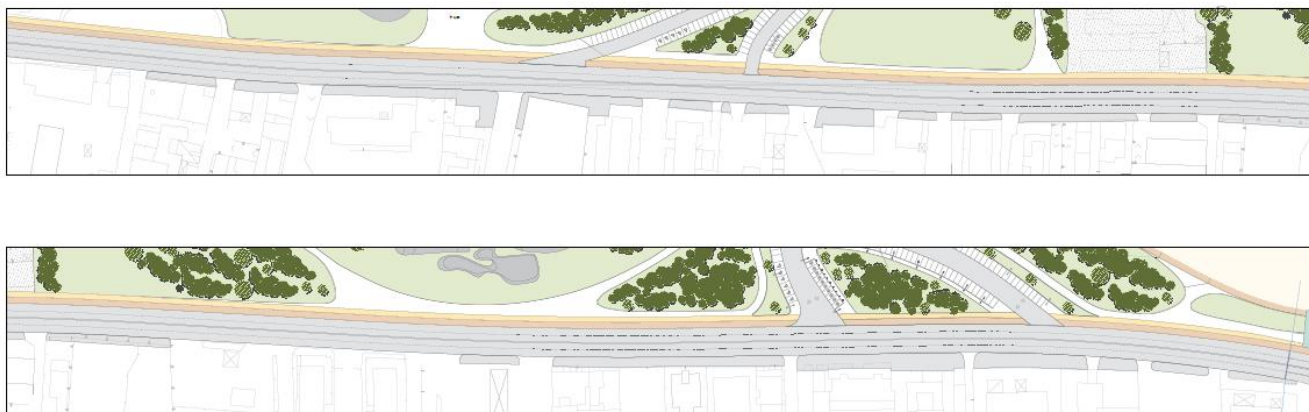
Planimetria di progetto degli interventi migliorativi di via Messina Marine
